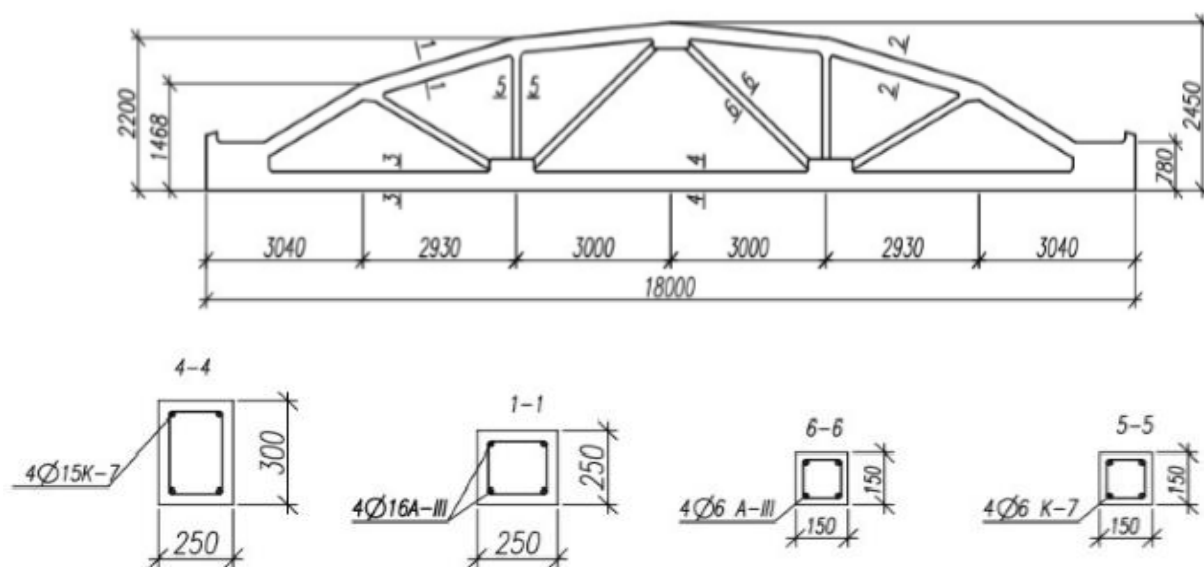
Геометрическая схема, поперечные сечения и армирование фермы
